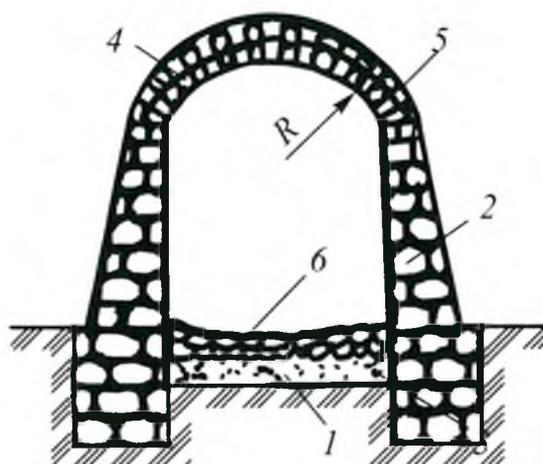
Поперечный разрез каменной трубы с вертикальными стенками и сводом:
